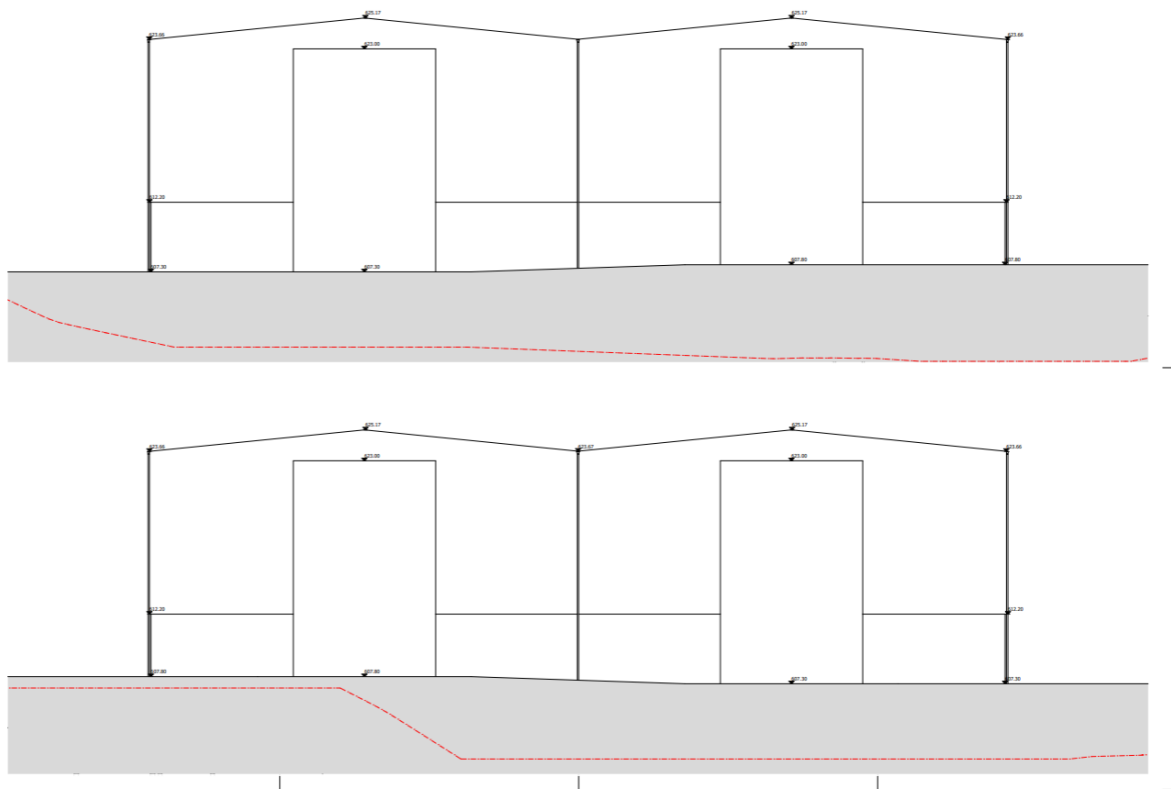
(Haut) Façade sud-est du hangar 9. (Bas) Façade nord-ouest du hangar 9. Extrait de [1].
